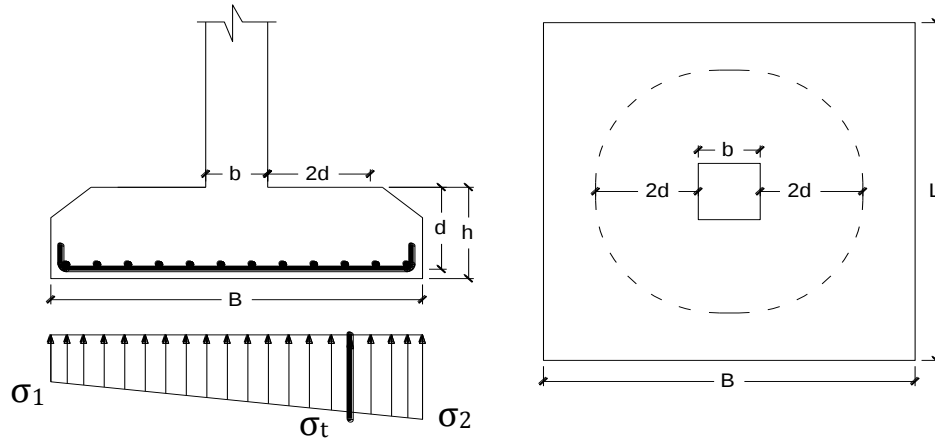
Cálculo a Punzonamiento en zapatas aisladas
